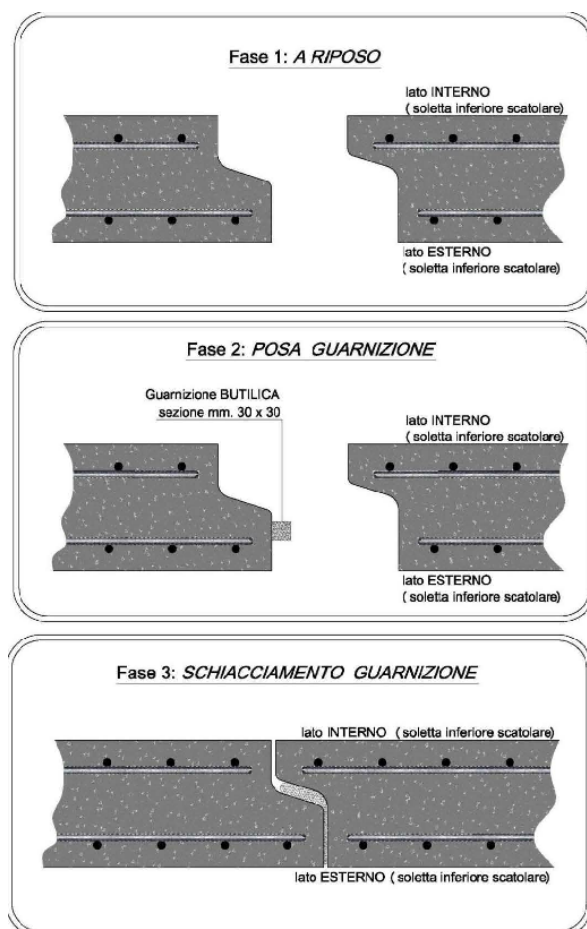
Schema installazione tipo guarnizione butilica nella giunzione tra elementi scatolari pref.
